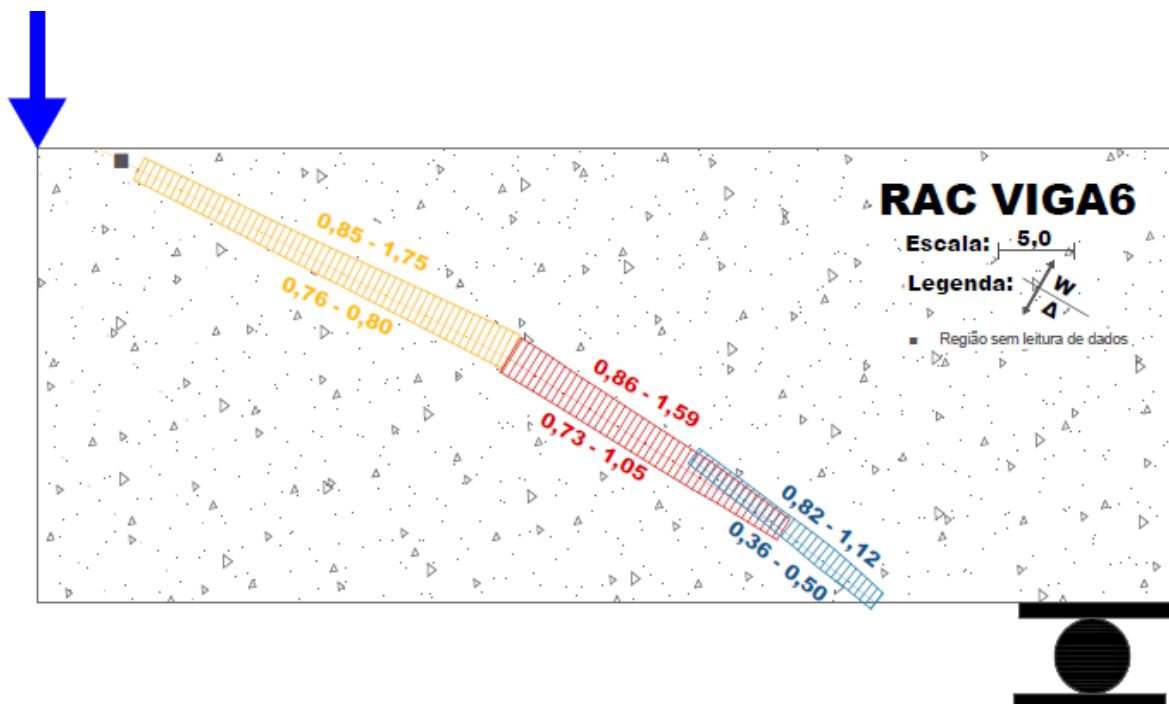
Abertura (w) e deslizamento (Δ) da fissura diagonal crítica da viga RAC-6.
